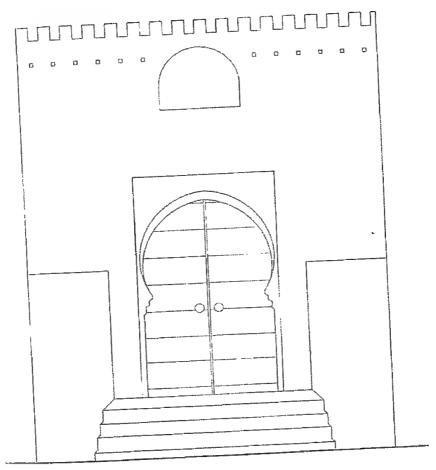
مسقط أفقي كروكي لبواية ساحة القرسان، عمل الباحث.
